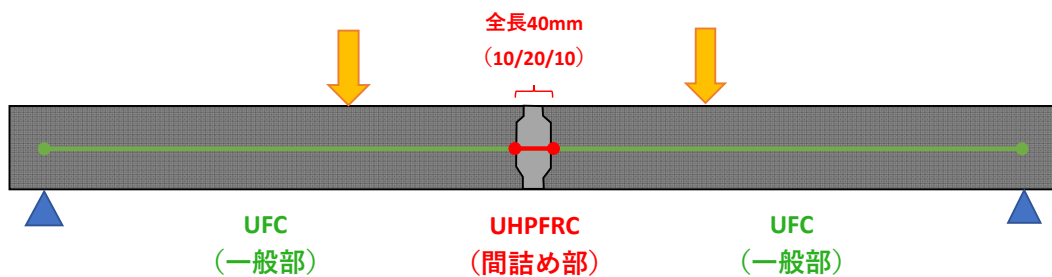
試験体 KJ の形状図と解析モデルの概要
